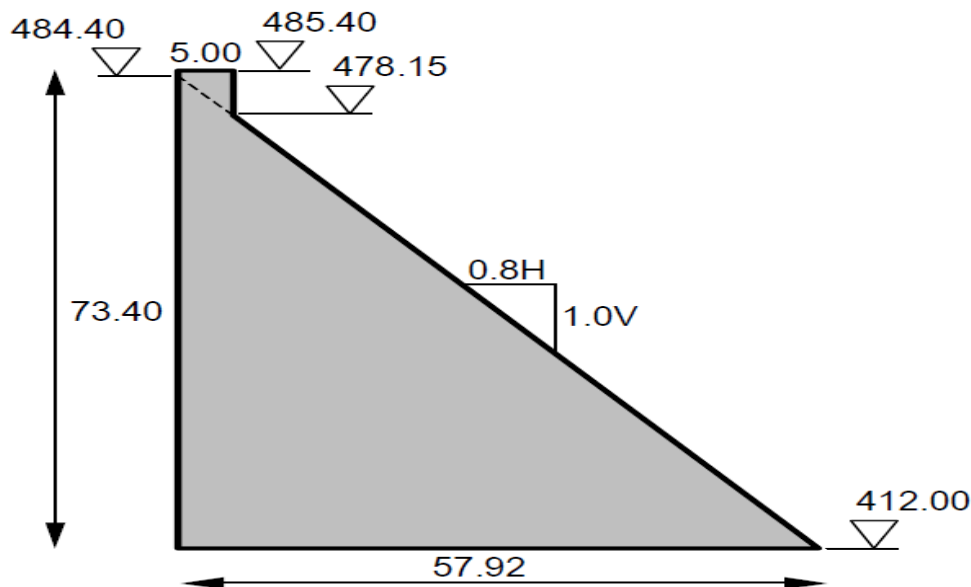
Section type non déversante du barrage Source [ANBT]
